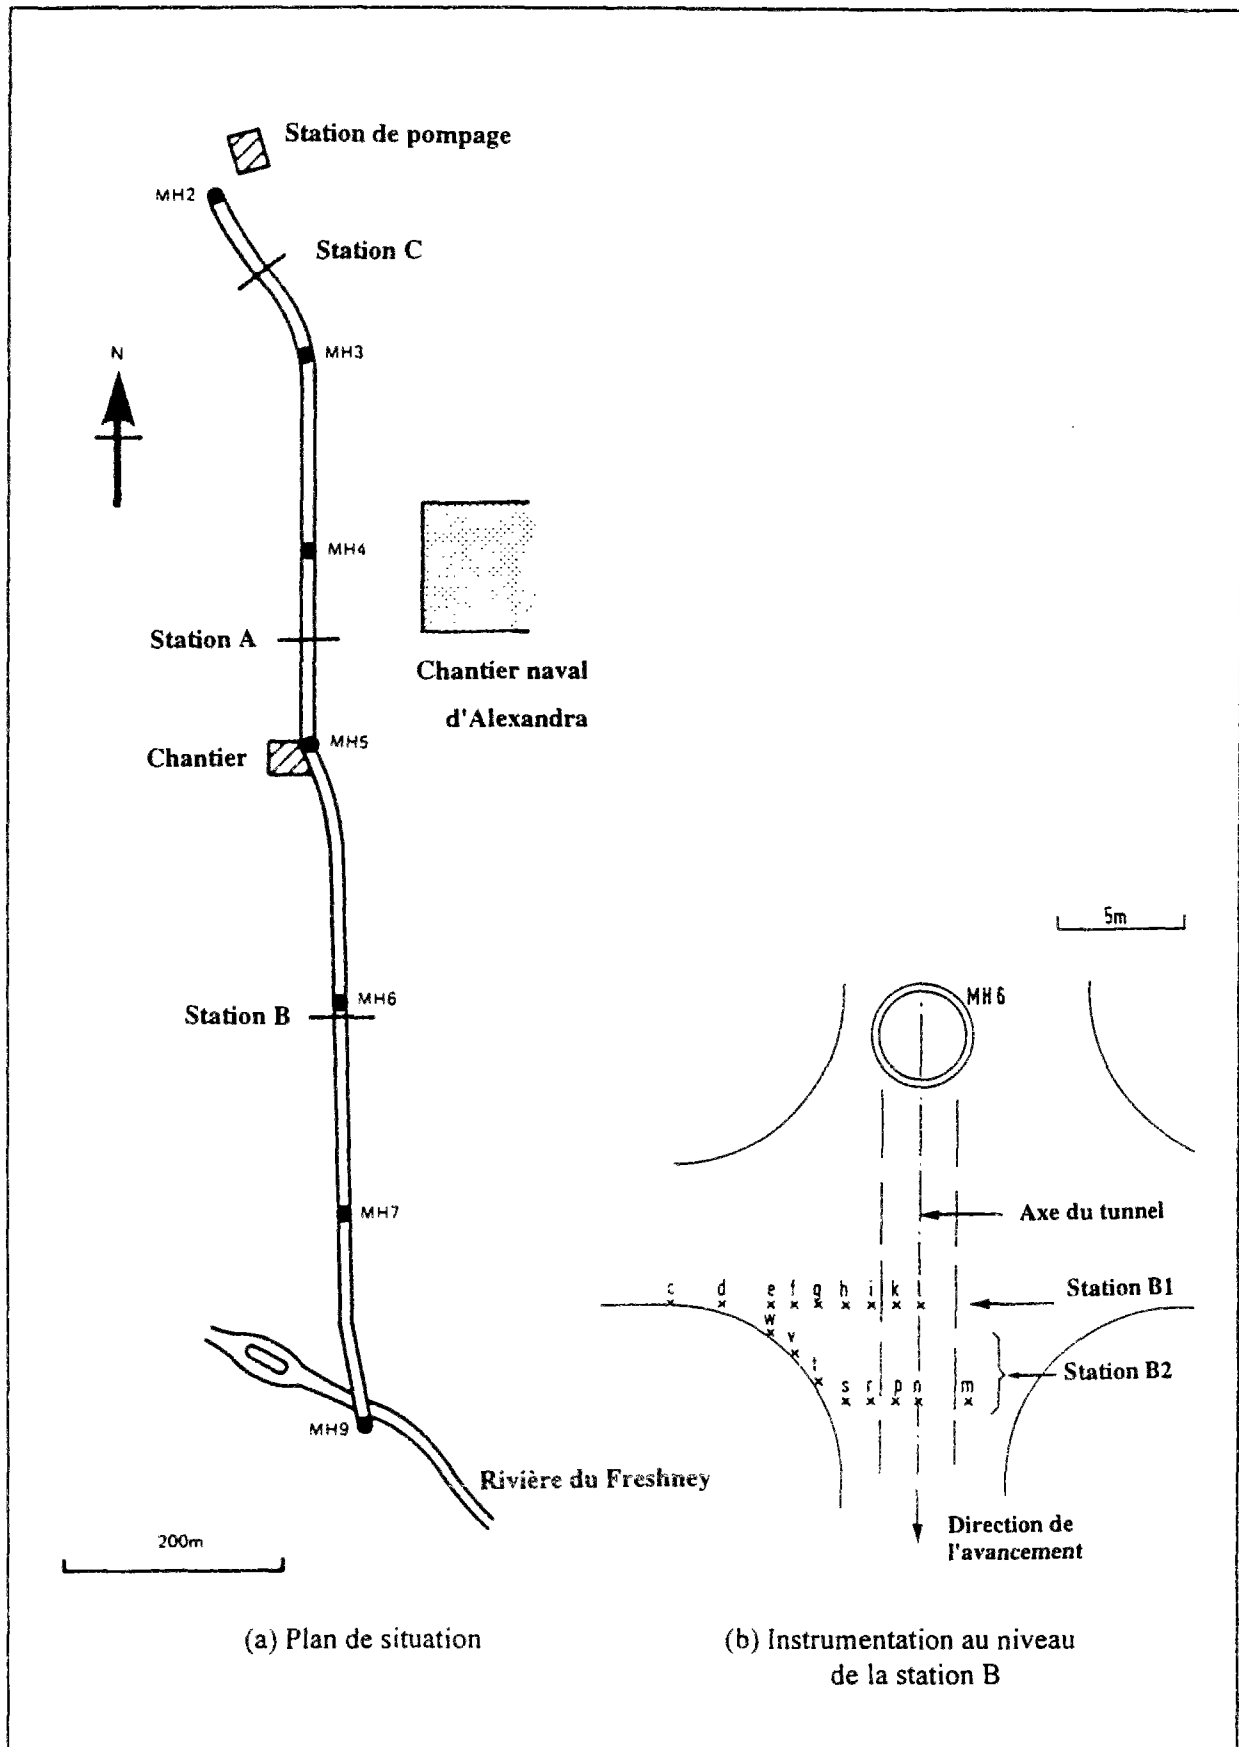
Plan de situation du tunnel de Grimsby et position des stations de mesures.
